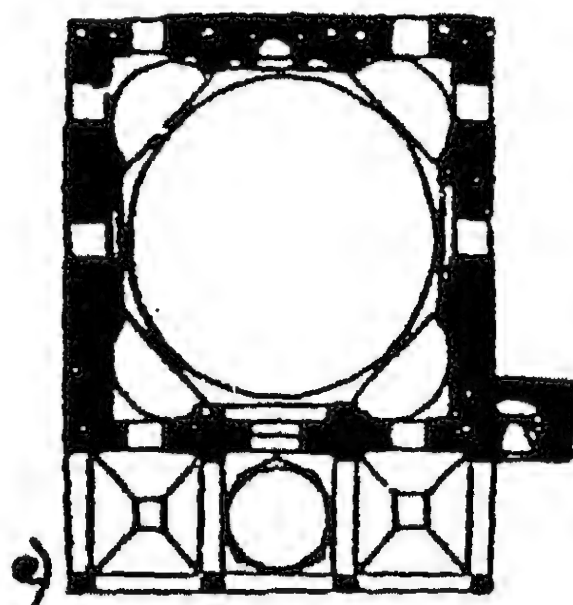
مسقط أفقي لمسجد الآجا في قالقاندلن (عن: Ibrahimgil).
